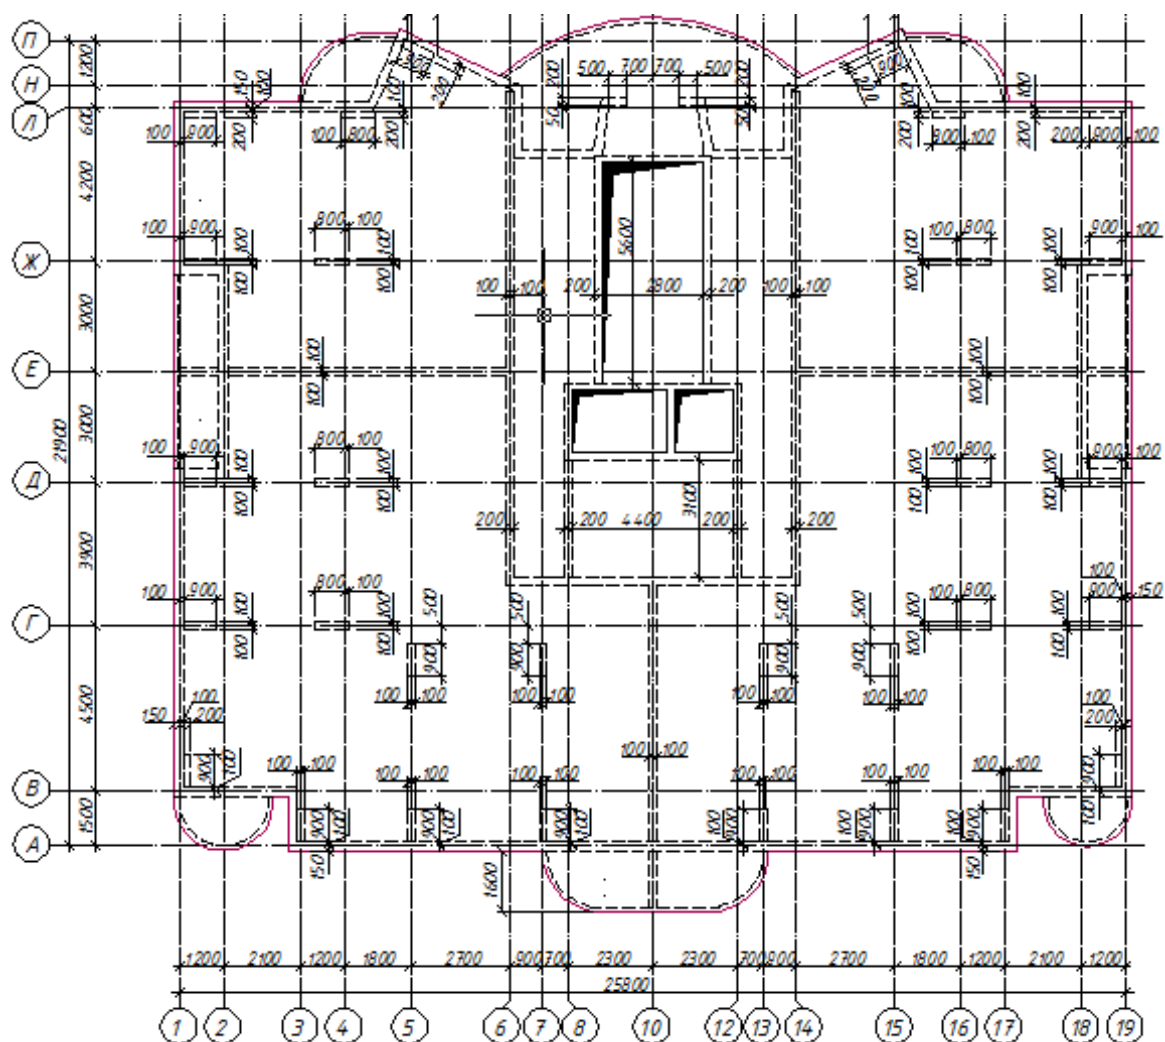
Рассматриваемый участок монолитной плиты перекрытия 3-го этажа
